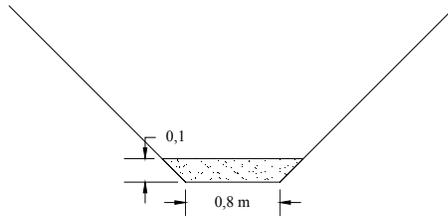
Tanah Urug pada Pondasi Kolam
